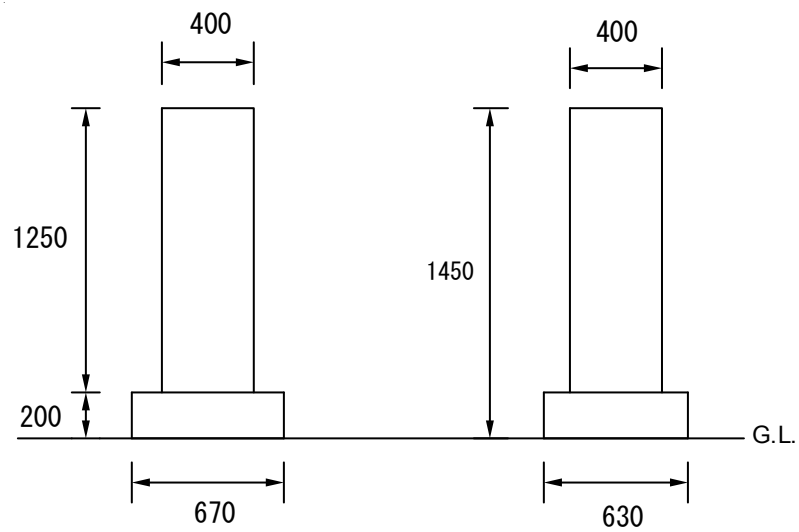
CB 門柱立面図 (単位: mm)
